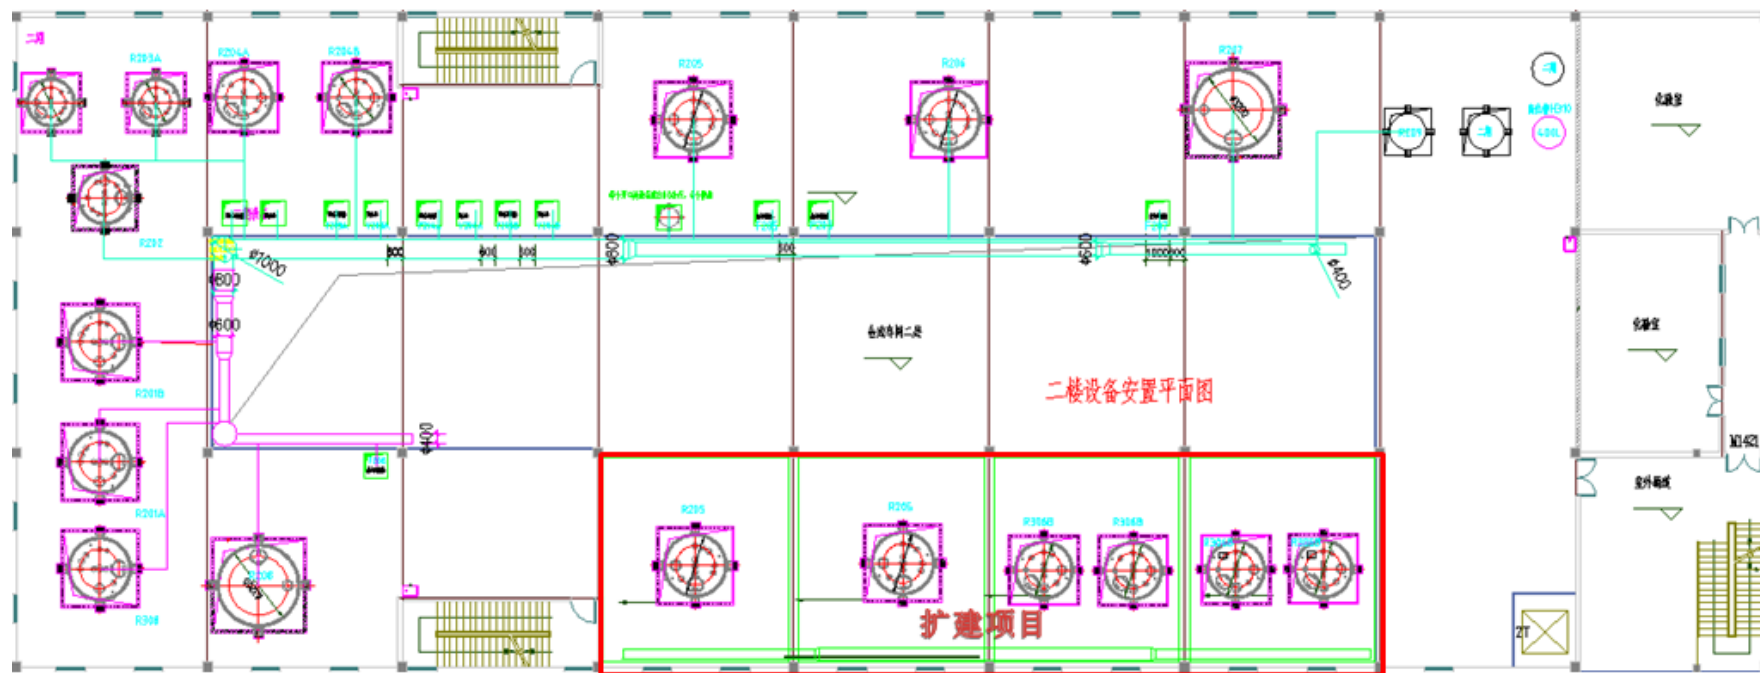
合成车间 2F 扩建项目设备平面布置图
